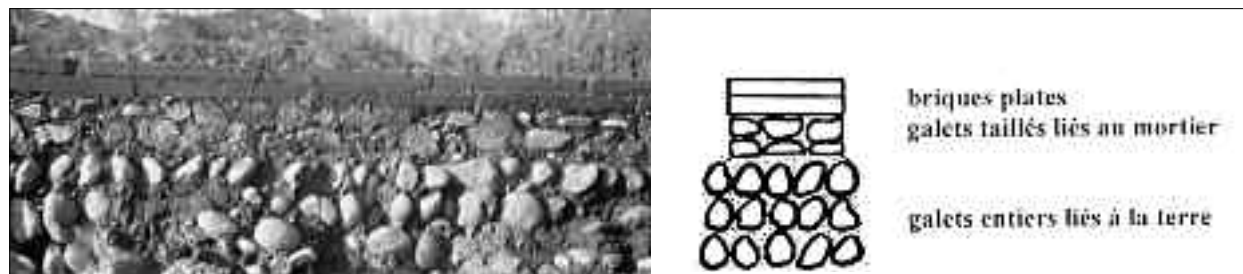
FONDATIONS DU GRAND BÂTIMENT :
